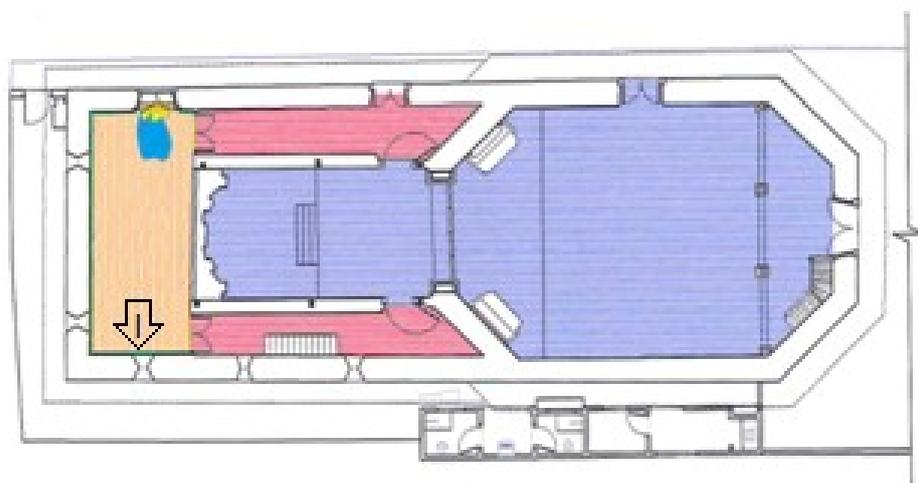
Vista I -Sacristia - Planta pavimento inferior Capela Sem escala.
